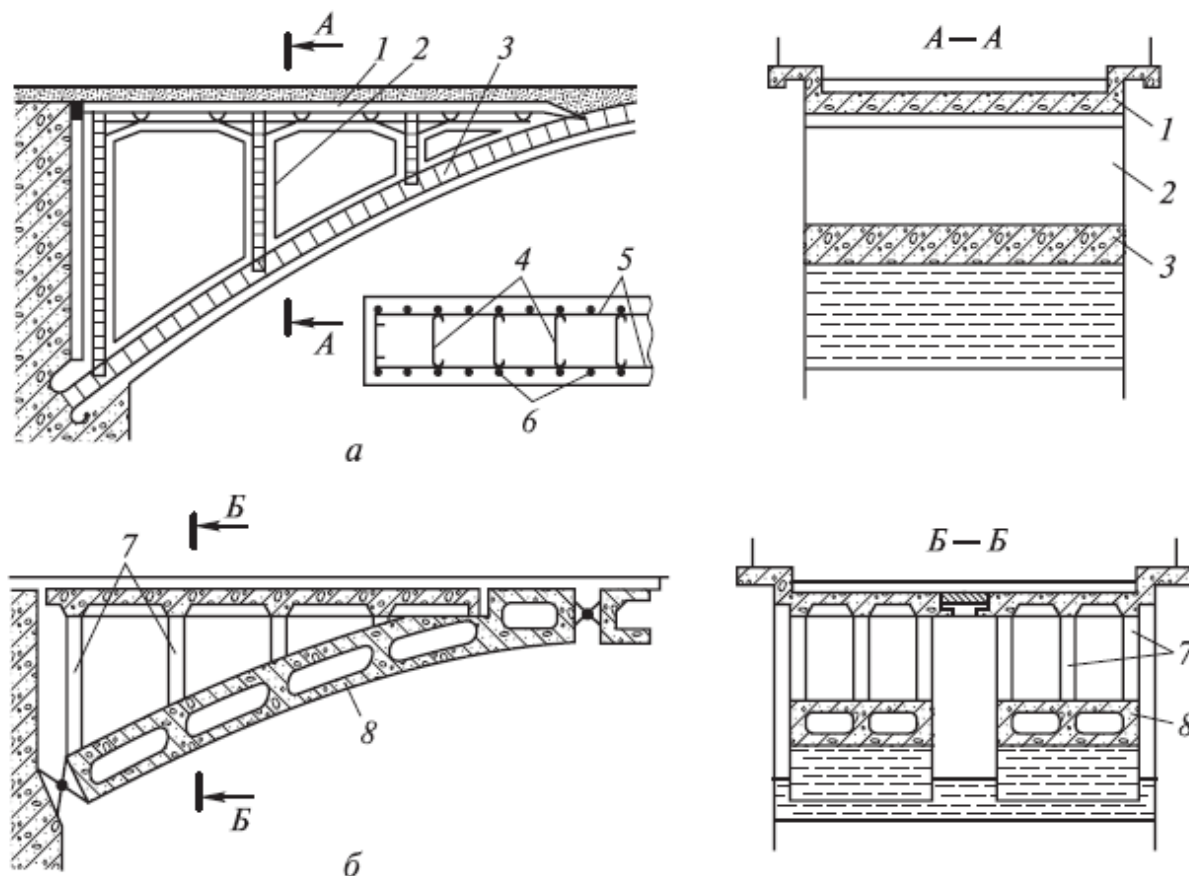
Конструкция надсводных строений с прямоугольными (*а*) и коробчатыми (*б*) сводами:
